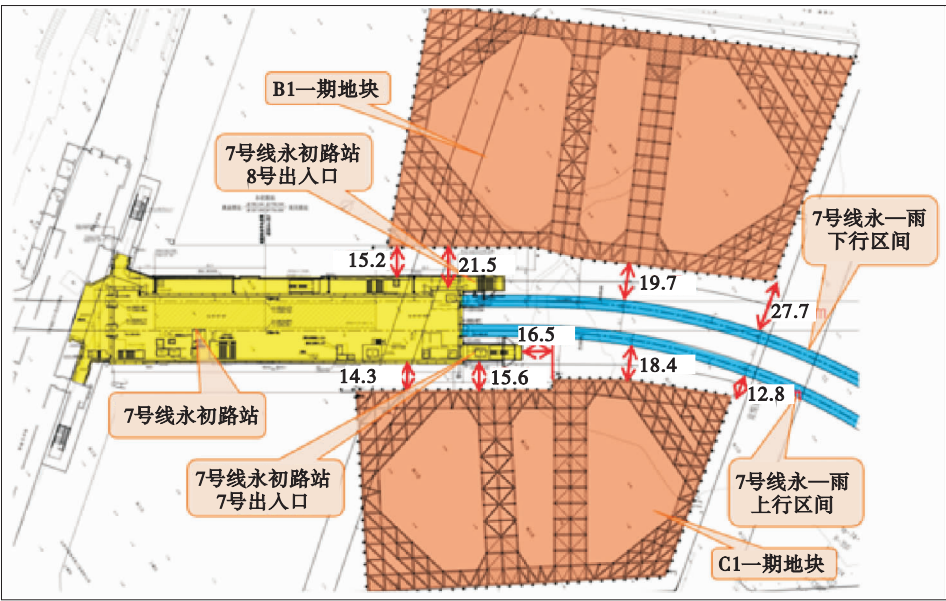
拟建 B1、C1 基坑与 7 号线车站的平面位置关系(单位:m)
